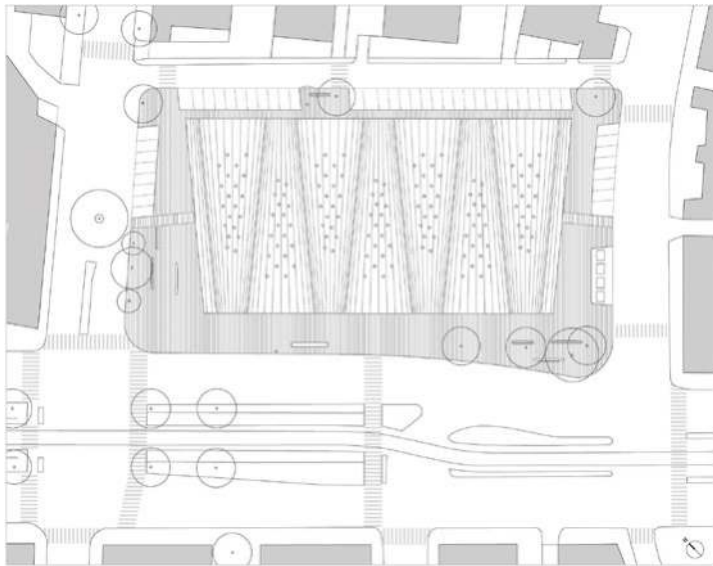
pianta piano terra del mercato; pianta delle coperture.
